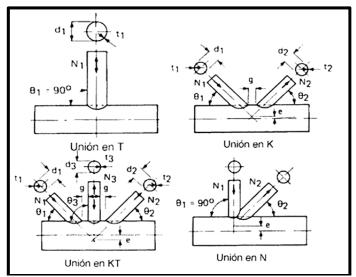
Unión soldada con perfiles tubulares directamente soldados entre sí // Fuente: Unicom
